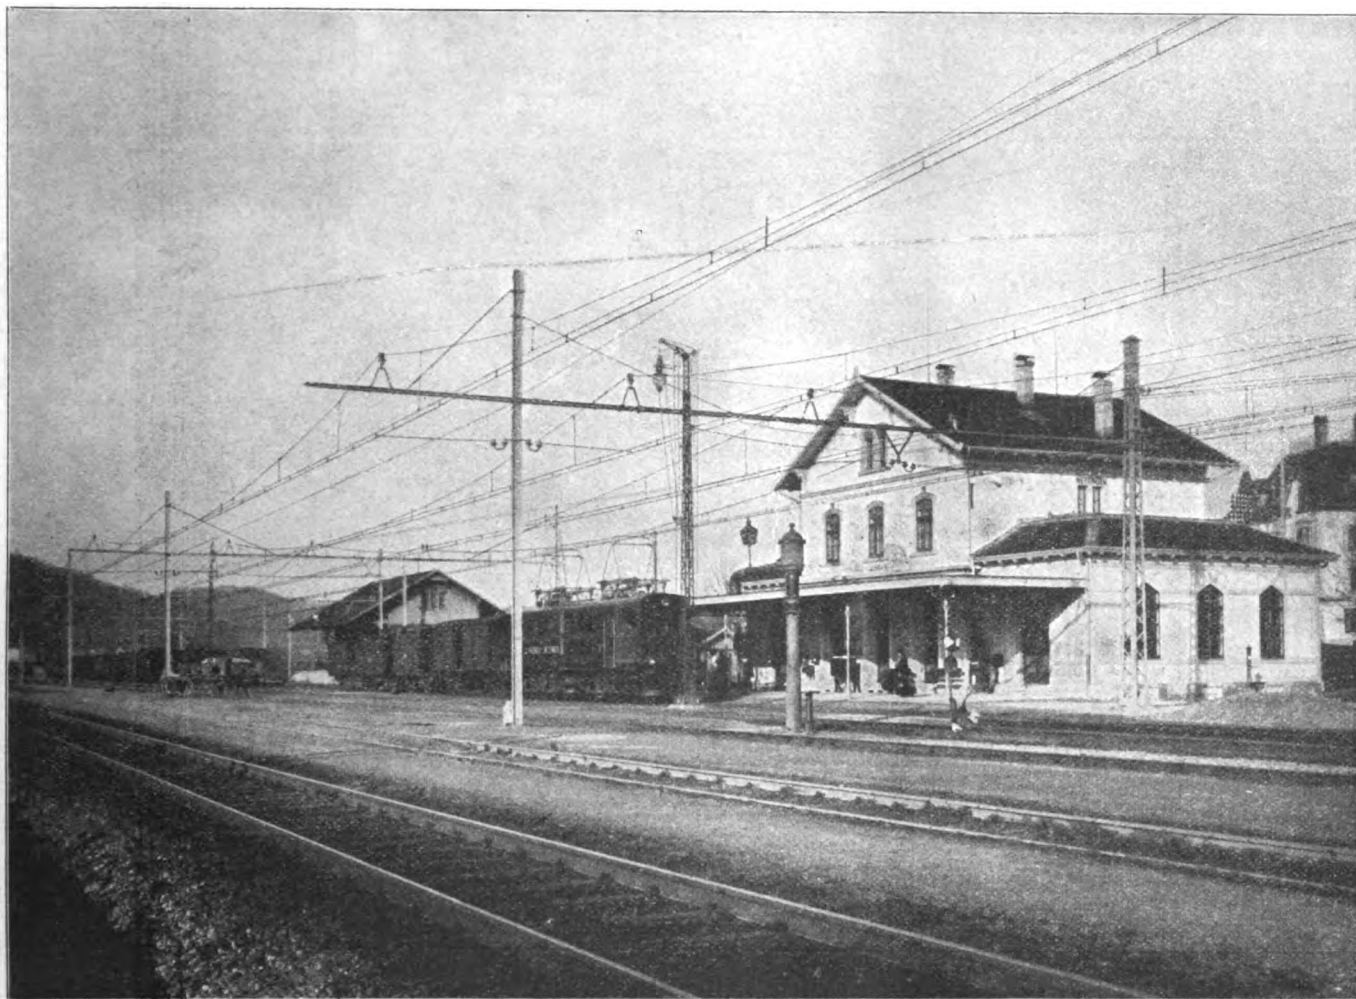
Disposizione delle condutture nella stazione di Wettingen.
